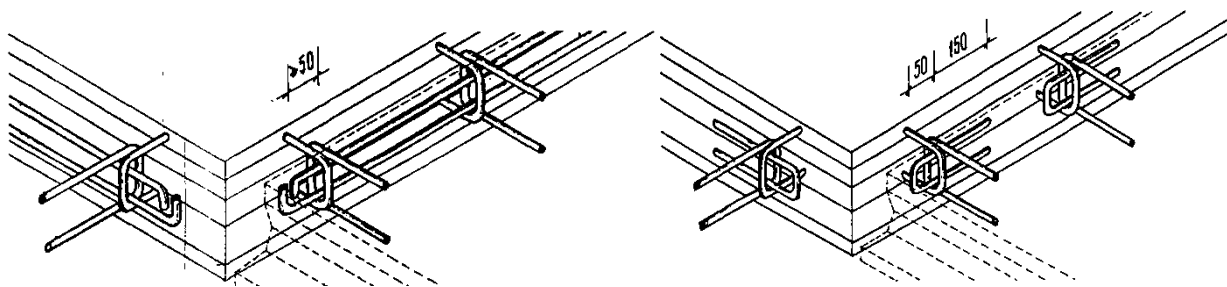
Схема армування стків плит перекриття перед бетонуванням.
